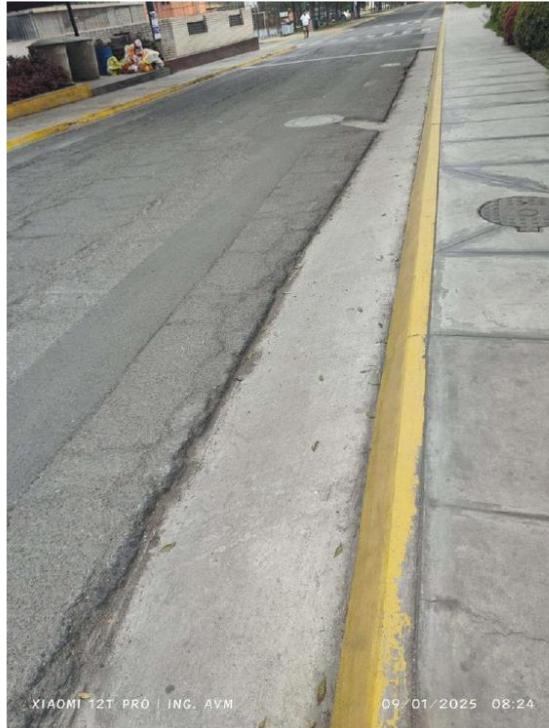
Piel de cocodrilo, agrietamiento longitudinal, desnivel entre reparación de concreto y pavimento asfáltico.
